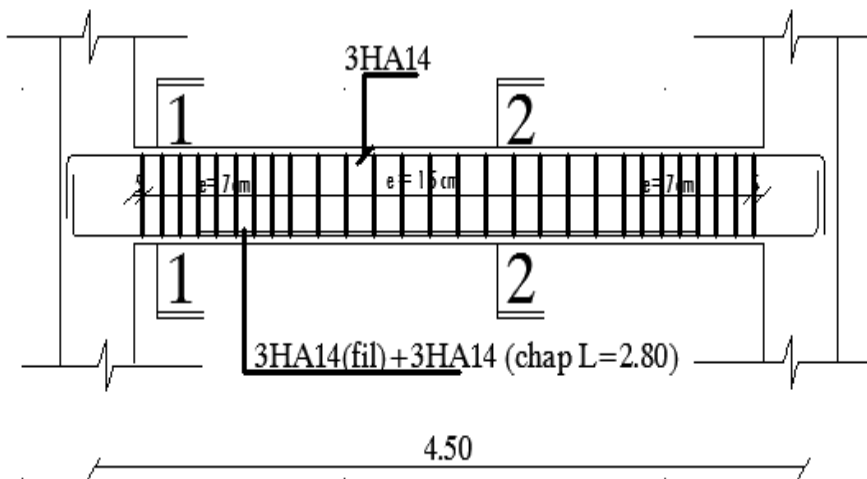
Schéma de ferrailage de la poutre palière
